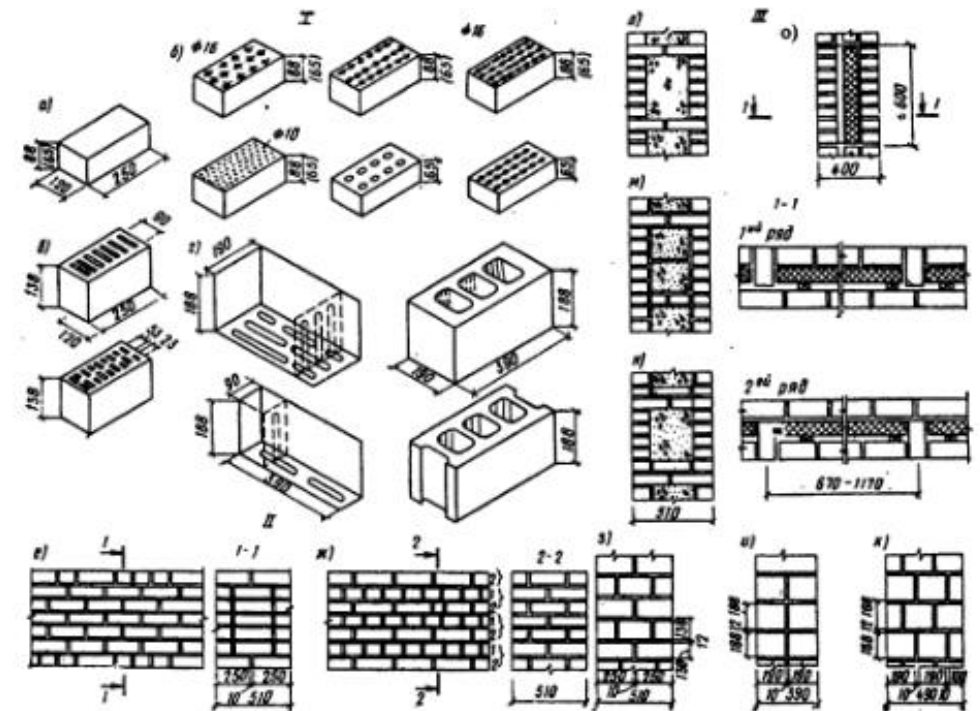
Материалы и виды кладок каменных стен: I - стеновые камни; II, III - кладки стен сплошные (II) и облегченные (III); а - кирпич сплошной; б - кирпич пустотелый; в - керамические камни; г - легкобетонные камни с щелевыми пустотами - целый и половинный; д - то же, трёхпустотный тычковый и ложковый; е - сплошная кирпичная кладка шестирядная; ж - то же, двухрядная; з - кладка из керамических камней; и, к - кладка из бетонных и природных камней; л, м, н - облегченные кладки с горизонтальными диафрагмами жесткости; о - облегченная кладка с вертикальными диафрагмами жесткости
